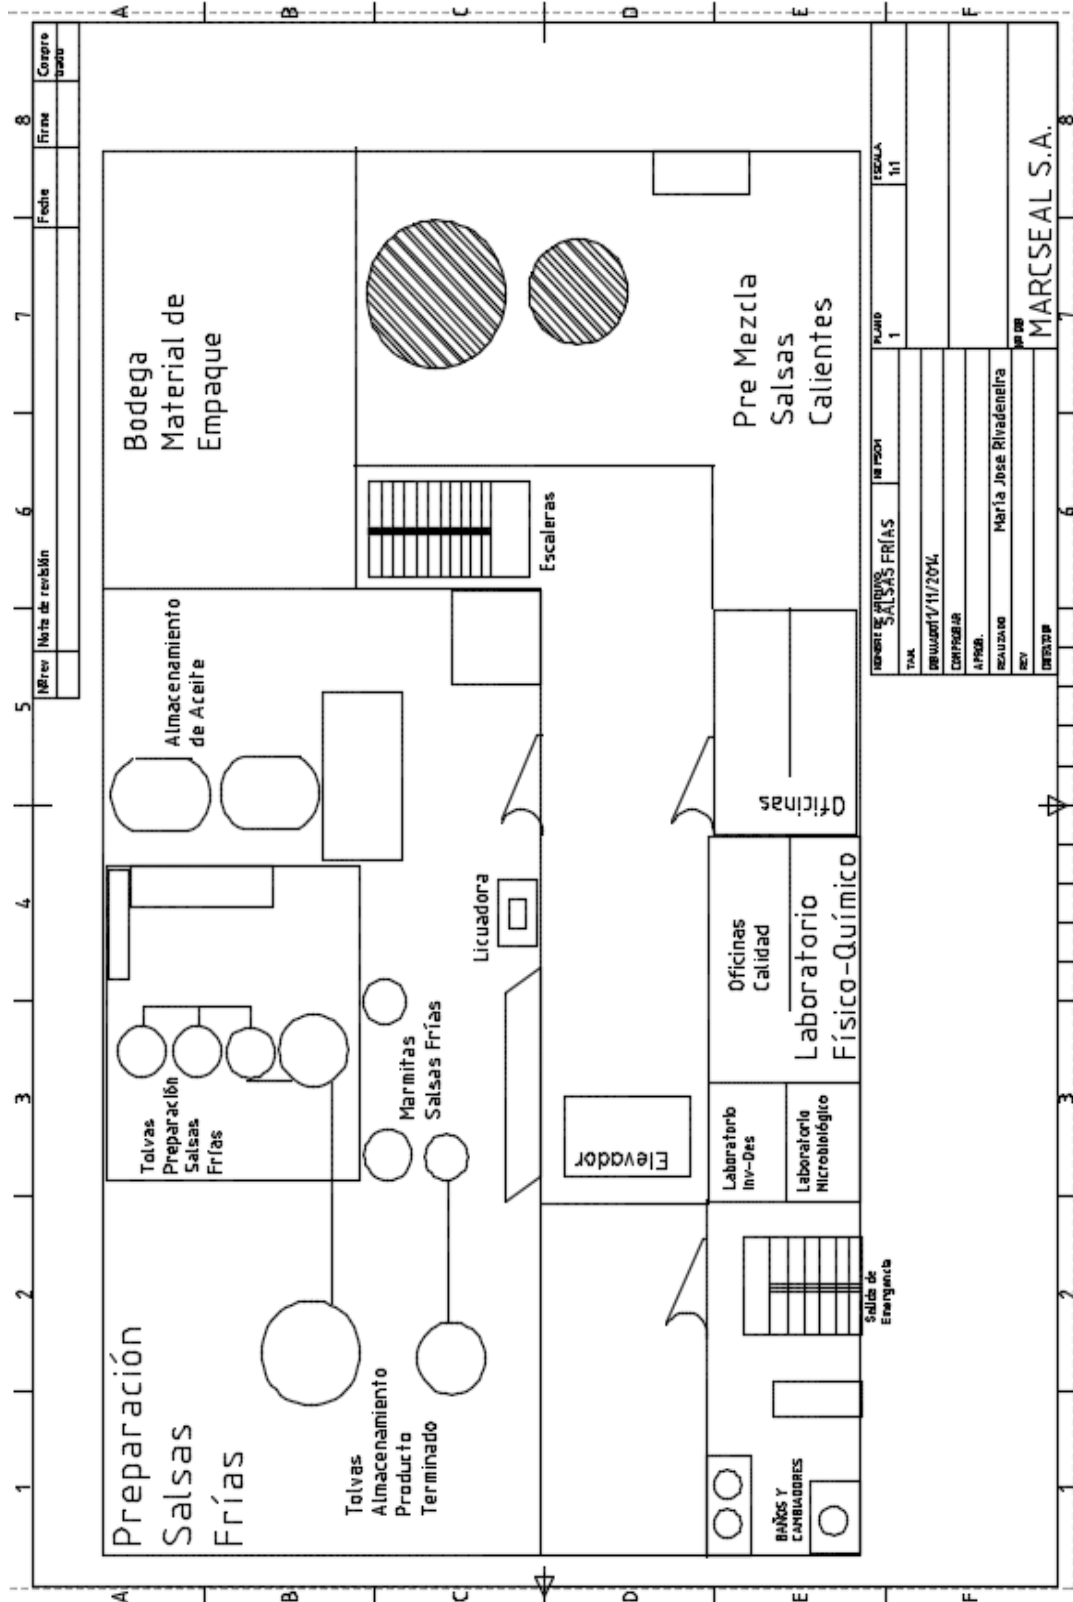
Disposición Actual de la Planta Elaboración de Salsas Frías
